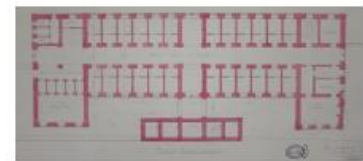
Plan du soubassement, extrait du Projet de construction de l'établissement thermal du Bouridé, 1874.
